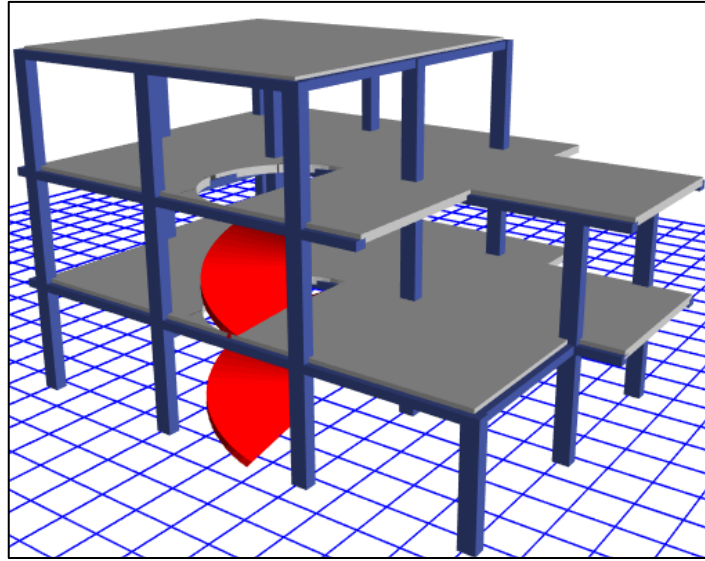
Vista en elevación del modelado en Etabs 2016 de la estructura de tres pisos
